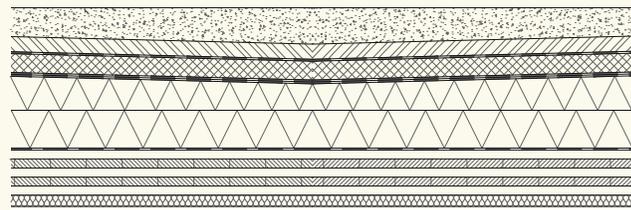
, technischer Aufbau eines extensiv begrünten Flachdaches | 1:20
